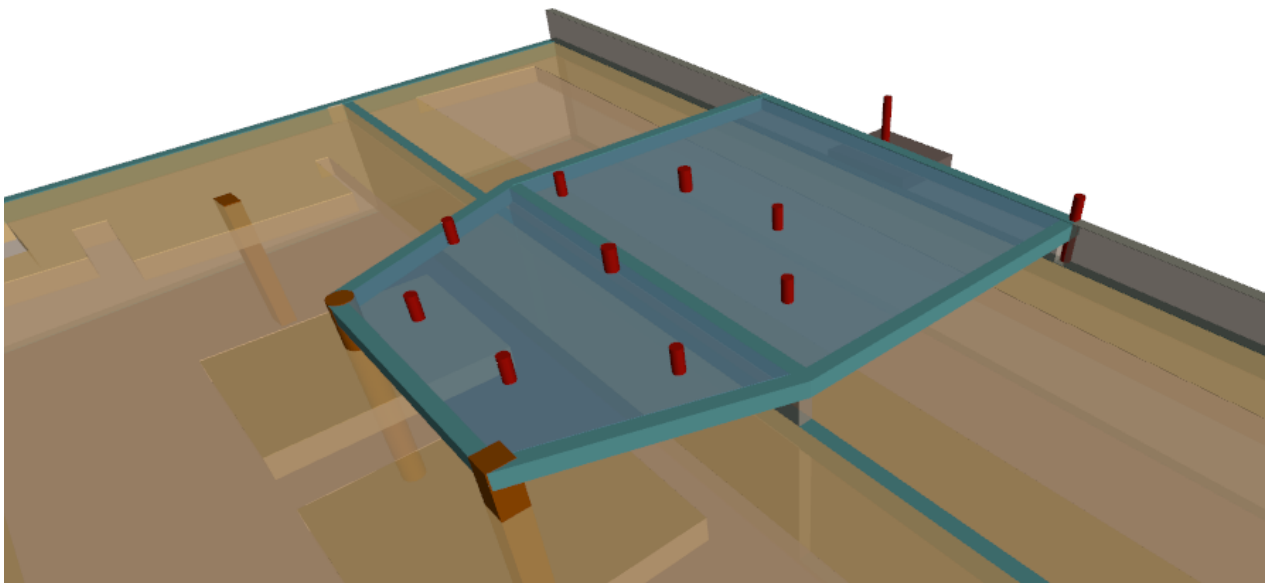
Modelo de losa de 35 cm en CYPECAD. Fuente: Memoria de cálculo para la instalación de parque Multiaventura sobre forjado del centro comercial LAGOH en Sevilla
